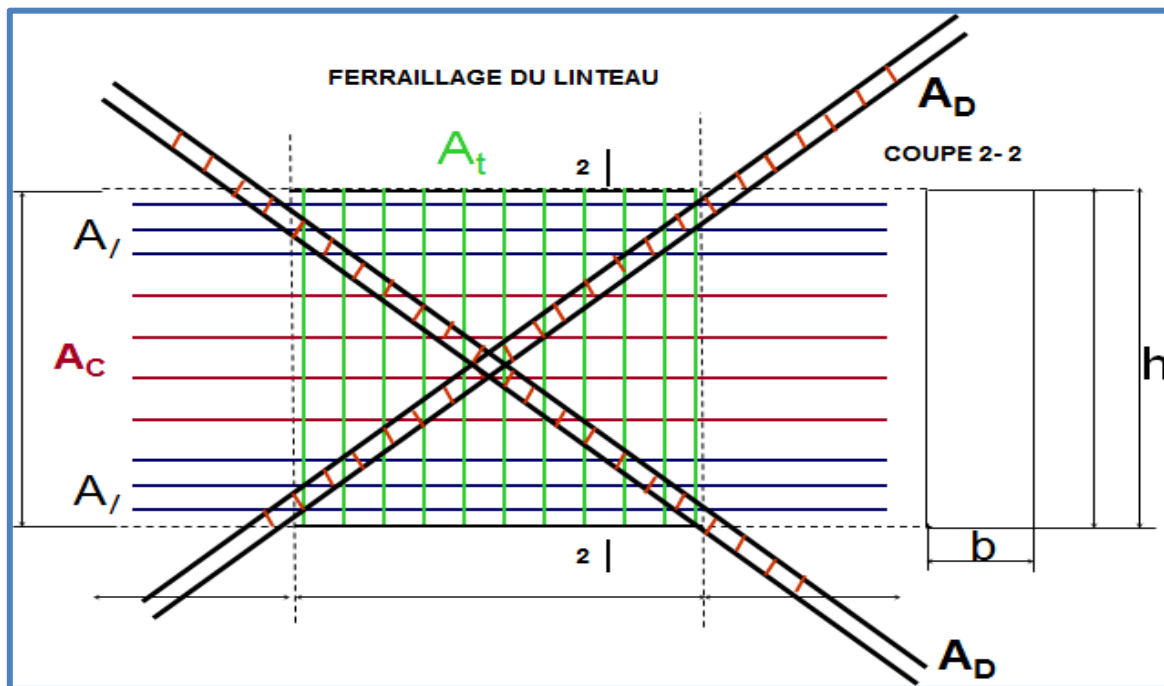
Disposition des armatures nécessaire dans le linteau
